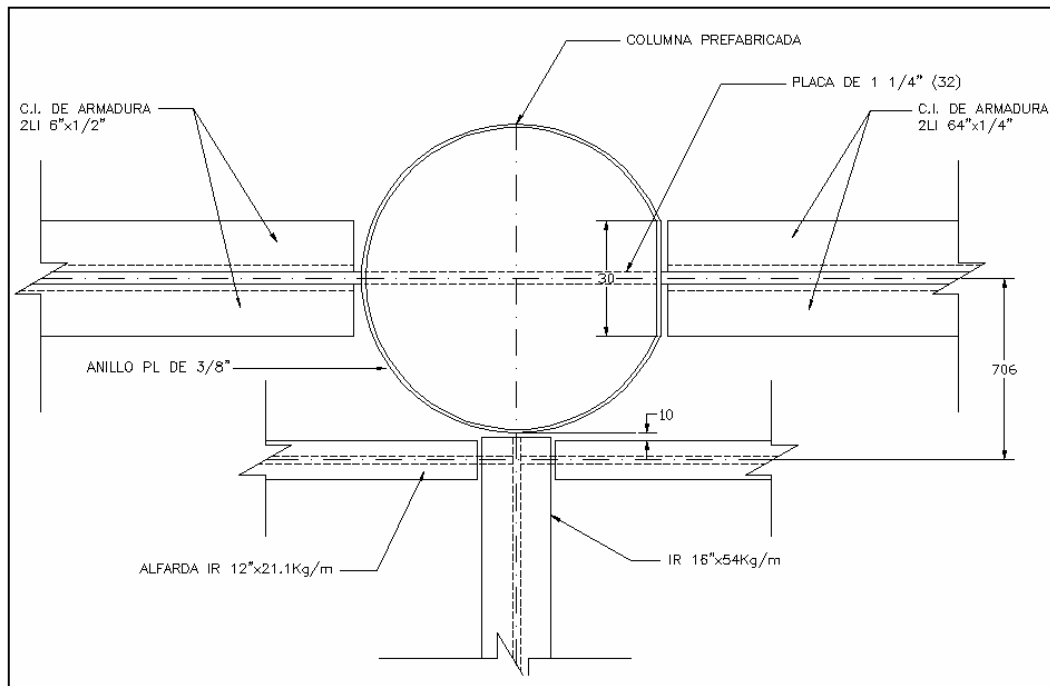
Conexión tipo (planta) para dar continuidad a la estructura metálica y estructura de concreto, consistió en colocar una placa que atraviesa la sección de concreto y sobresale para recibir las cuerdas de las armaduras metálicas, con la sección igual al área del ángulo de mayor sección.
